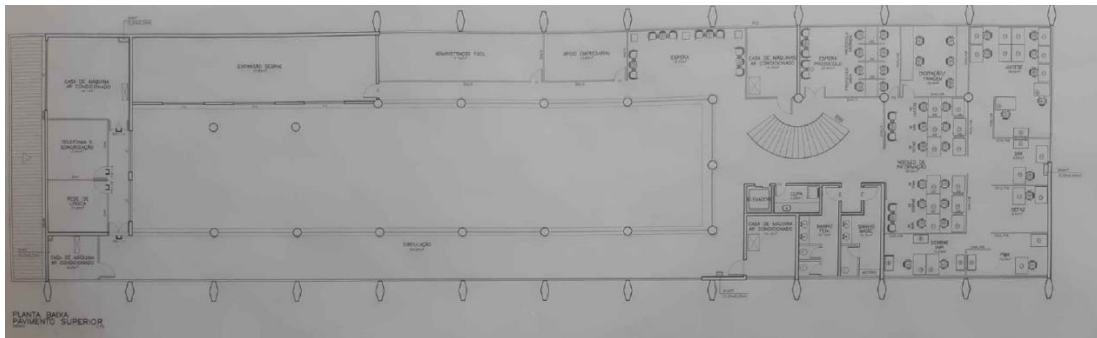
1999 / Planta do pavimento superior. ©Planta conseguida na CEHOP.
